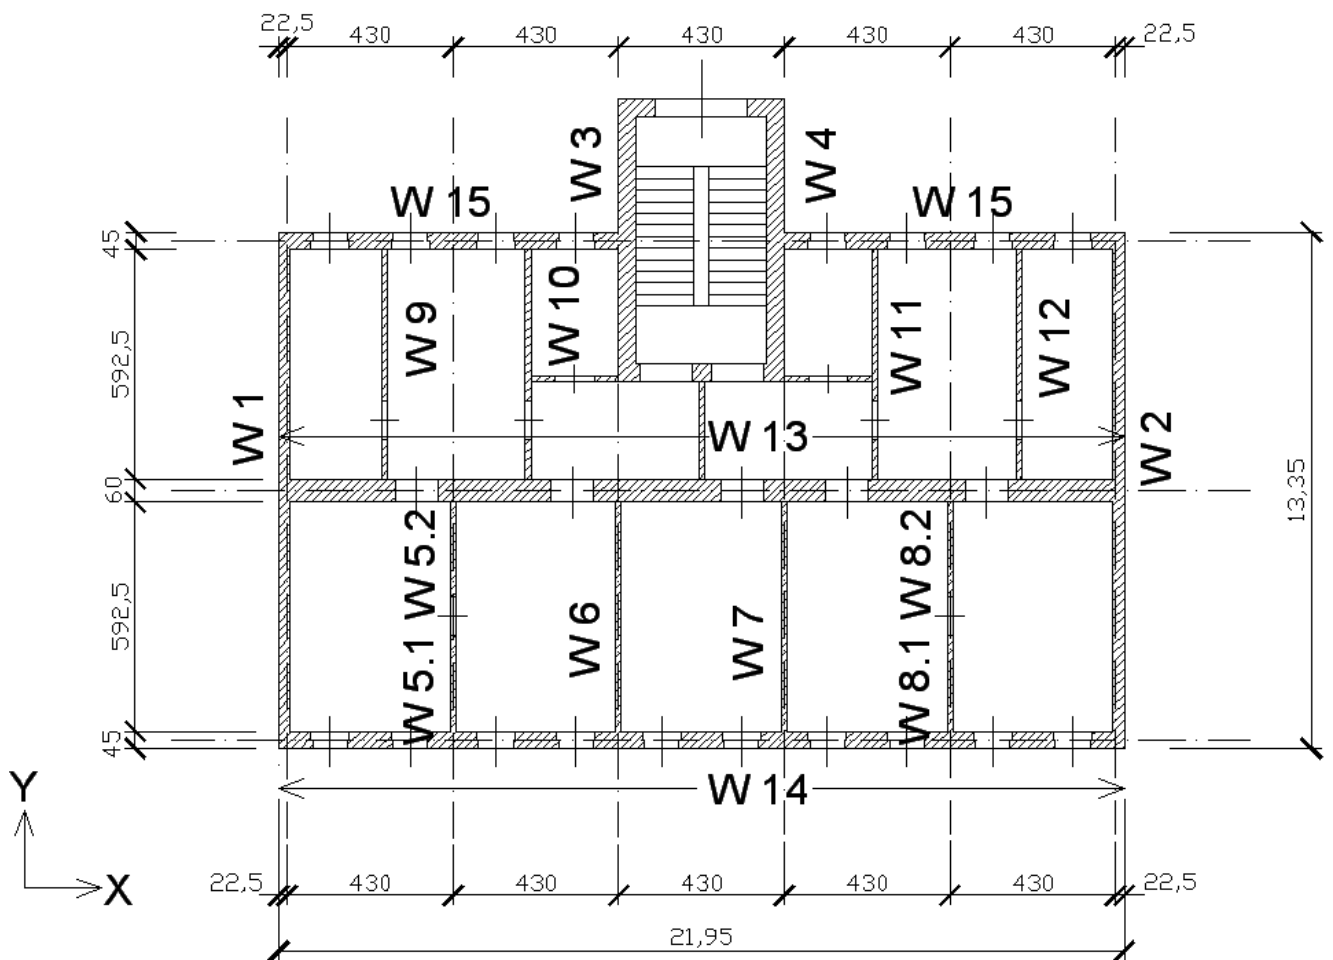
Grundriss 3.OG, Positionsplan
